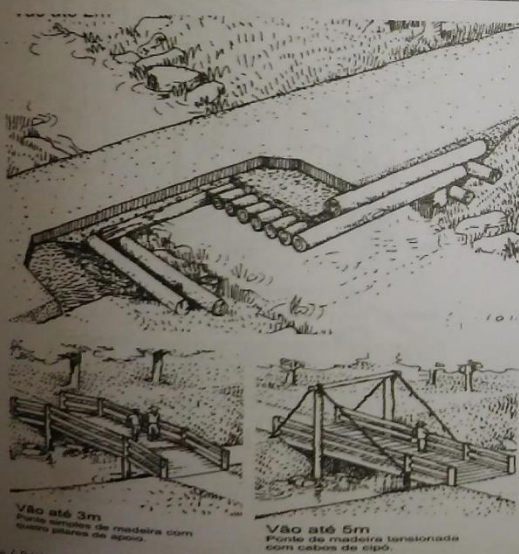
Sistemas construtivos para pequenas pontes de madeira.
